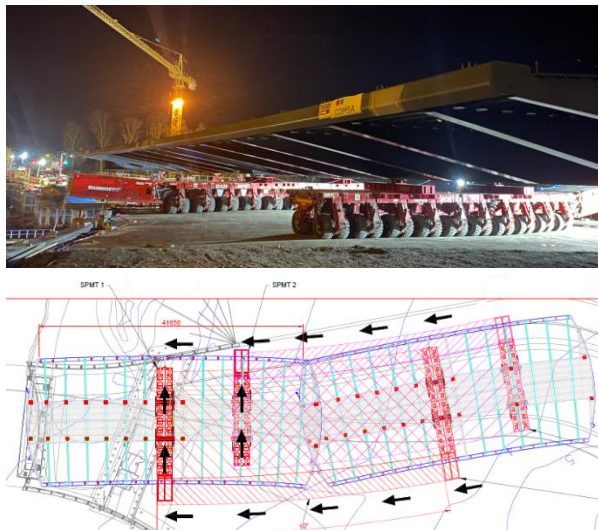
Fotografía y vista en planta del movimiento de los carretones SPMT
